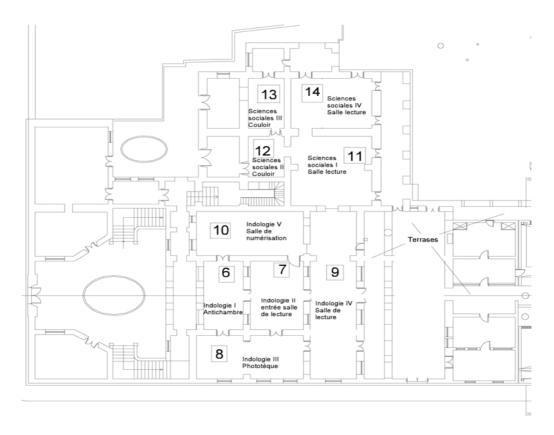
11, Saint Louis Street. Rez-de-chaussée.
